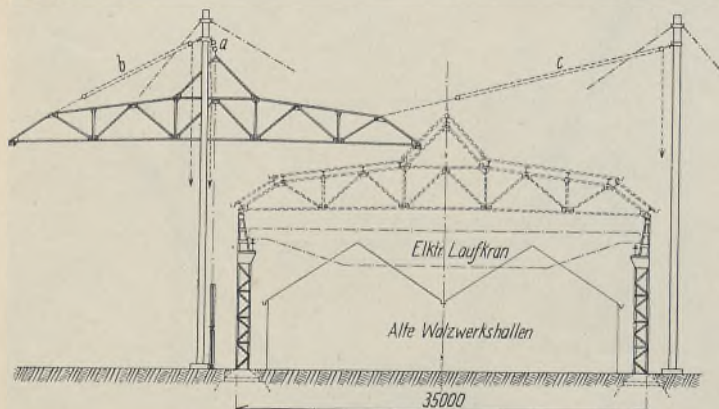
Umbau der Walzwerkshalle eines westfälischen Stahlwerkes. (Binder hochgezogen, um 90° geschwenkt und fertig zum seitlichen Vorholen).
